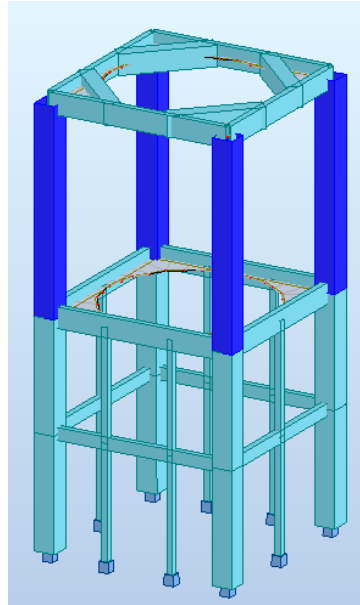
Pilares 1,0 m x 1,0 m do 2º troço
